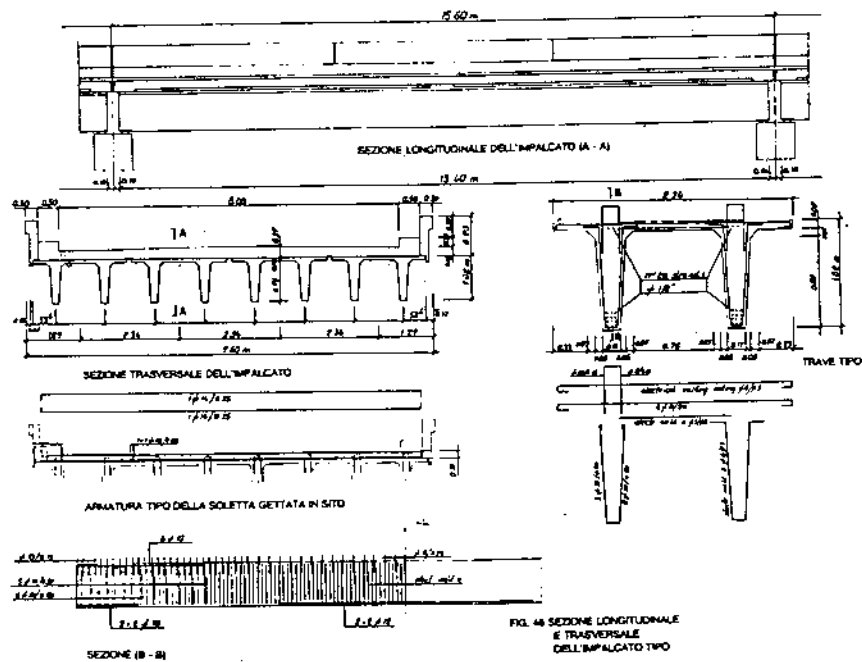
SEZIONE LONGITUDINALE E TRASVERSALE DELL'IMPALCATO TIPO
